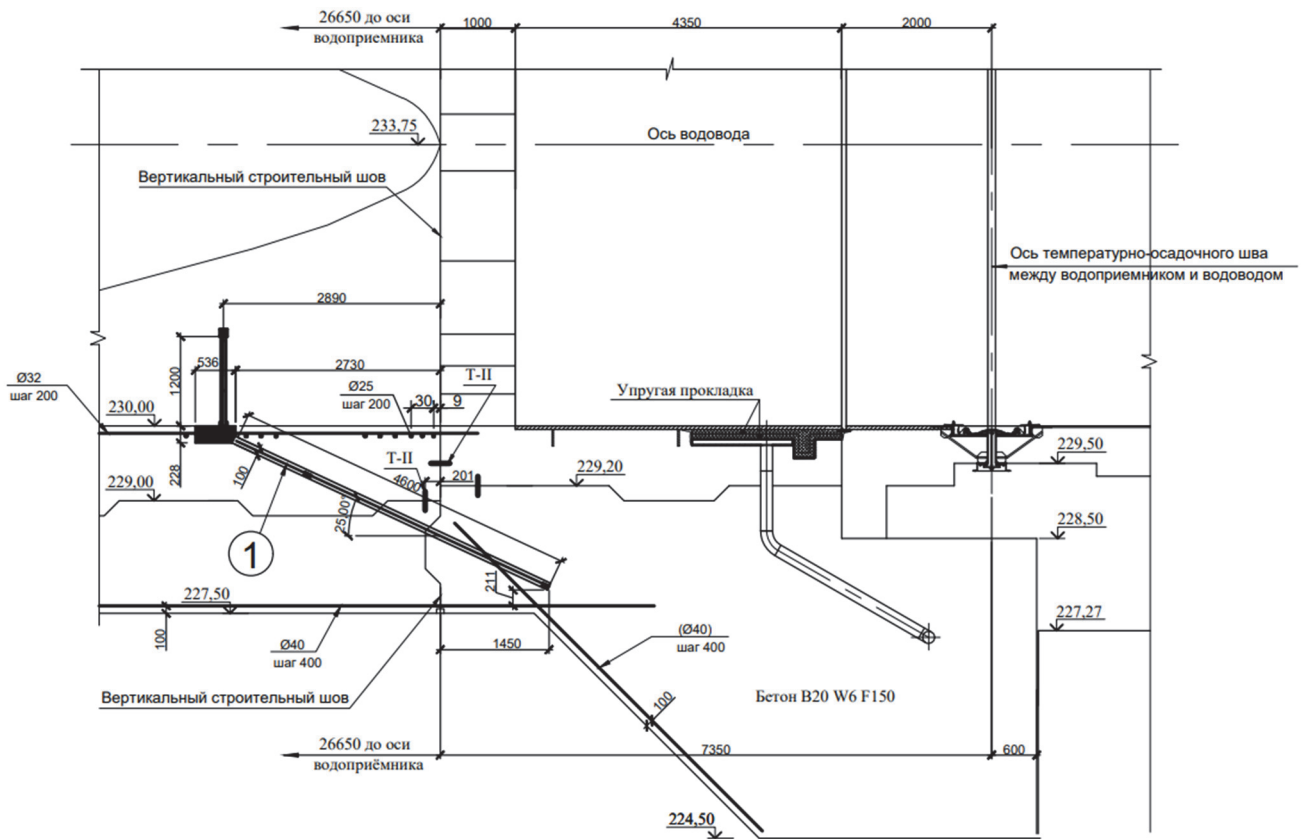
Схема усиления низового участка фундаментной плиты наклонными стержнями (анкерами):
